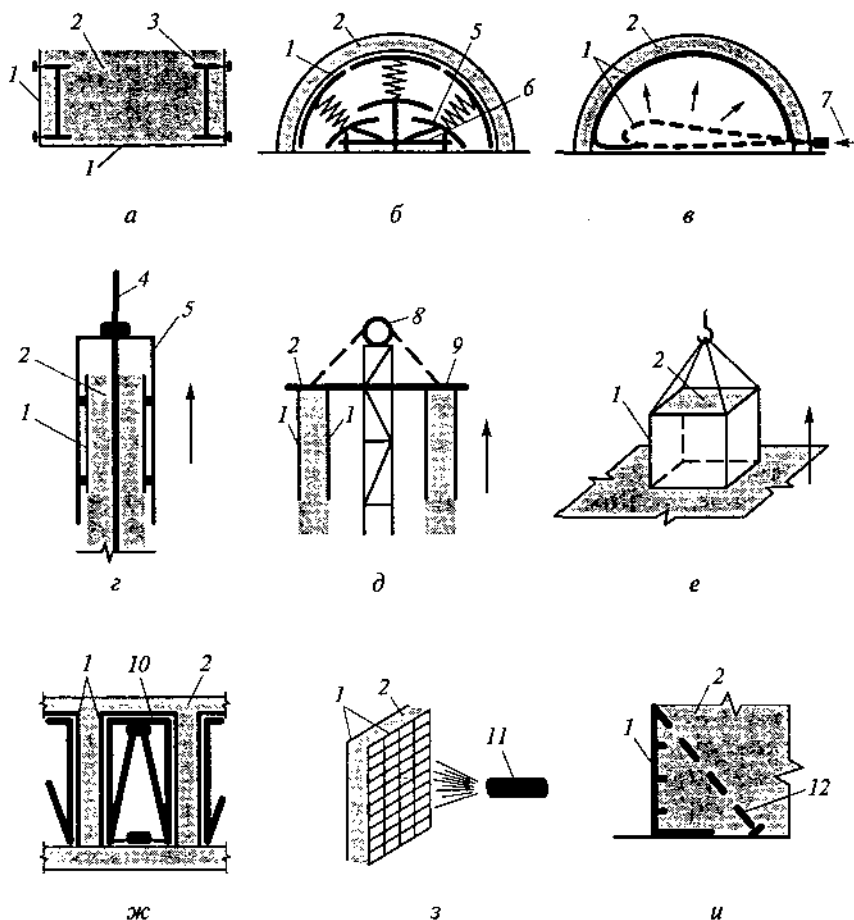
Схемы различных опалубок, применяемых в строительстве: а — подвесная; б — катучая; в — пневматическая; г — скользящая; д — подъемно-переставная; е — блочная; ж — объемно-переставная; з — армоопалубка; и — несъемная; 1 — опалубка; 2 — бетон; 3 — металлический профиль; 4 — металлический стержень; 5 — домкратная рама; 6 — тележка; 7 — воздух; 8 — лебедка; 9 — металлическое опорное кольцо; 10 — складная рама; 11 — сопло; 12 — растяжка
